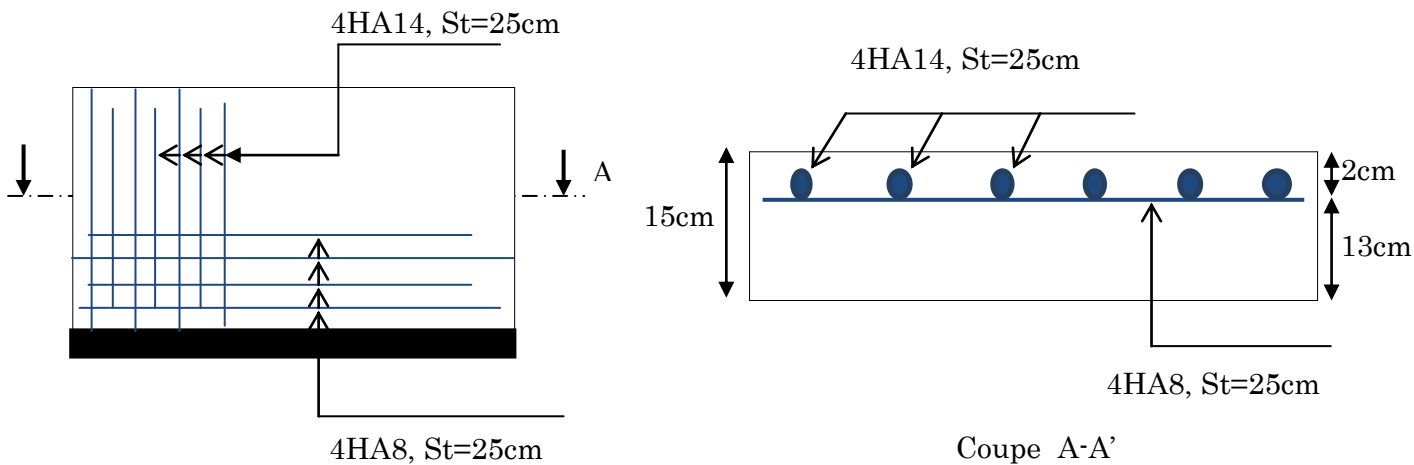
Schéma de ferrailage de la volée (CE) et le palier de repos de l'escalier type(1)
